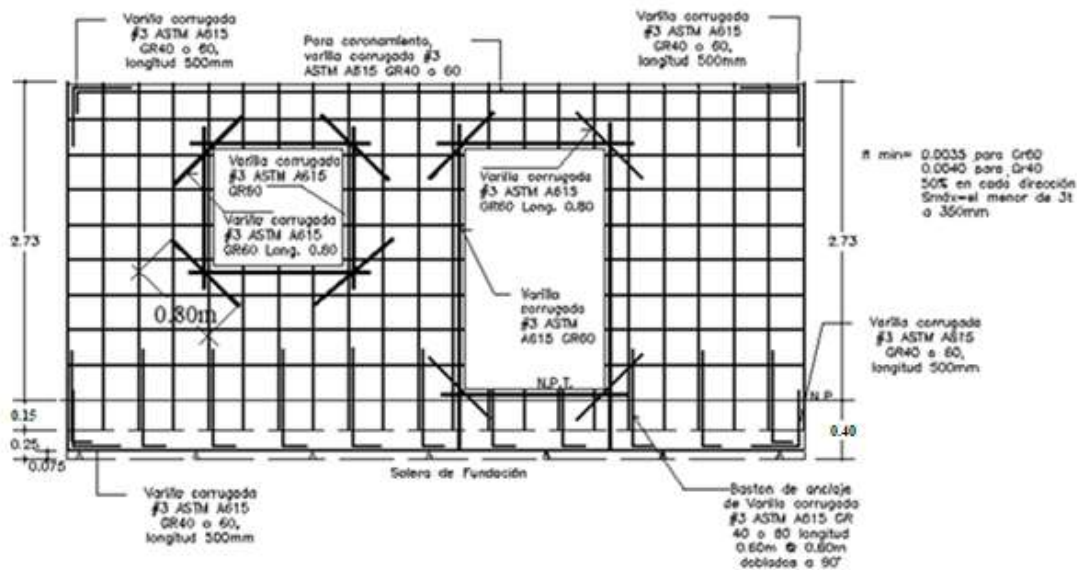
Requisito de refuerzo en aberturas en paredes de concreto reforzado, para viviendas de una y dos plantas, con aceros grado 40 y 60
